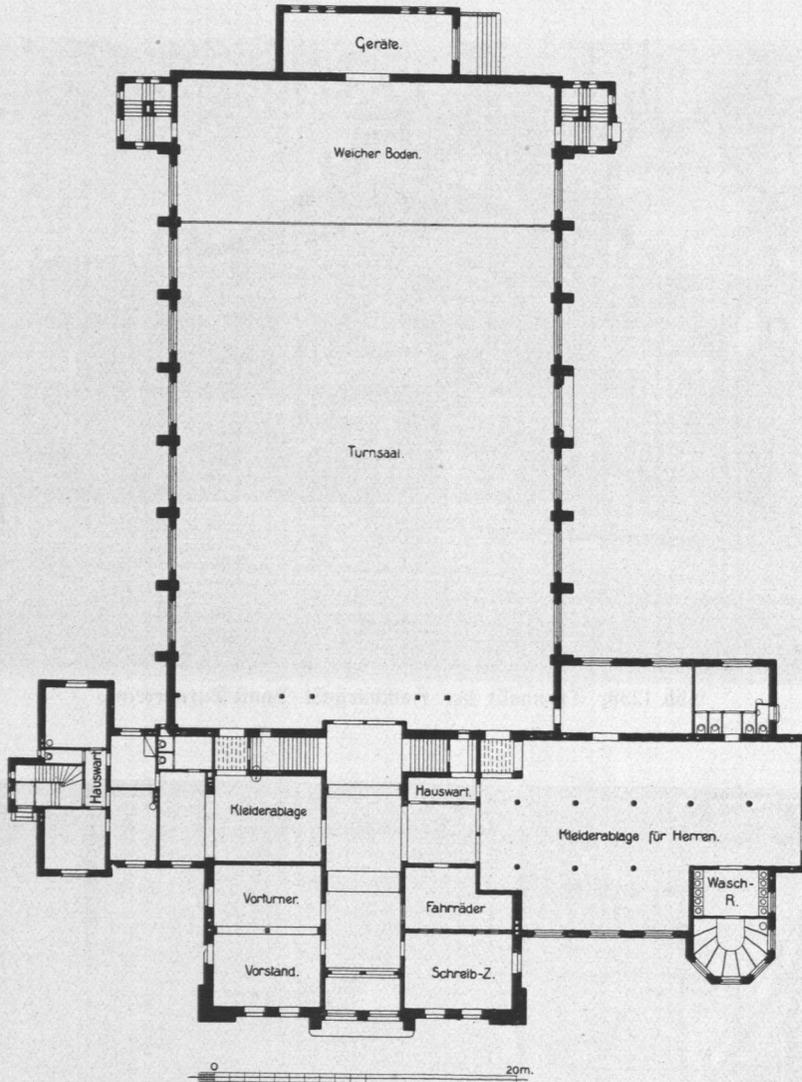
Turnhalle des Hamburg-St.-Pauli-Turnvereins, Grundriß.
